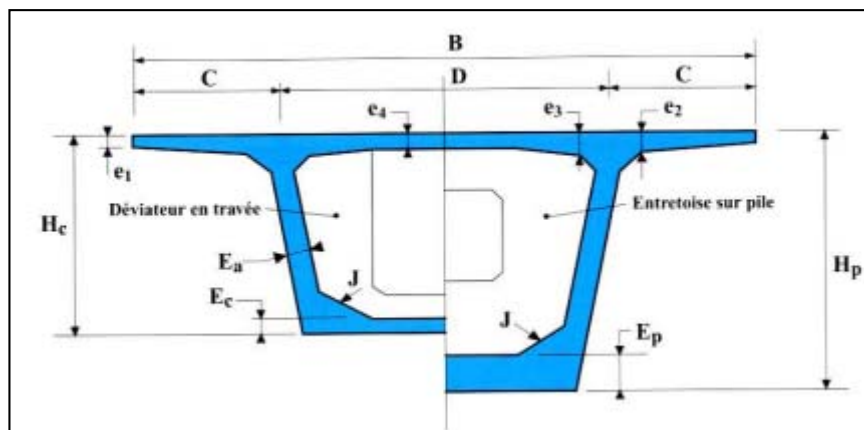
Symboles des dimensions d'un voussoir type [4]
